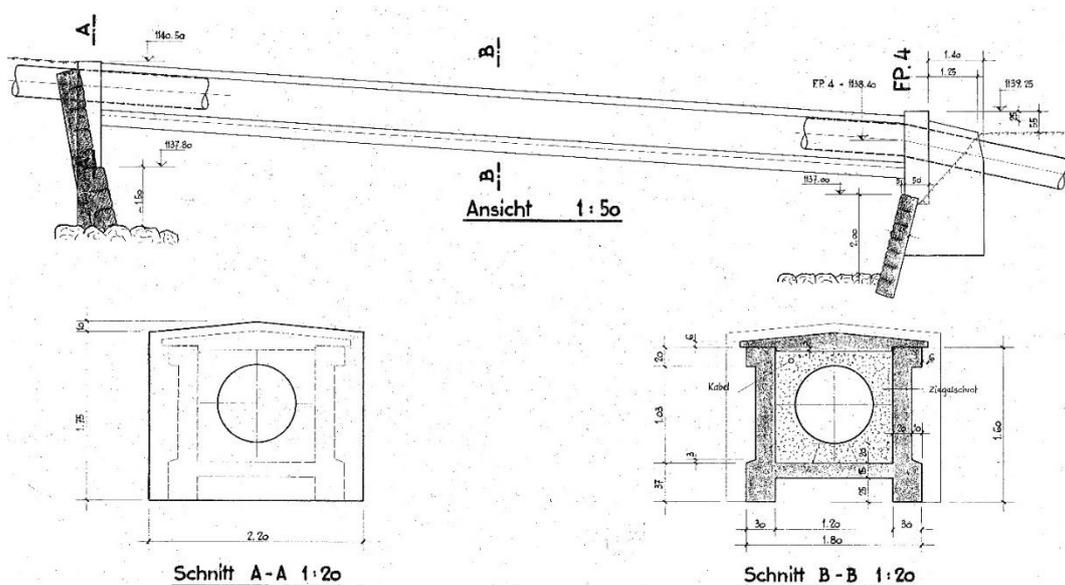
Bestehende Rohrbrücke (Ausschnitt Plan Nr. 500-134).
